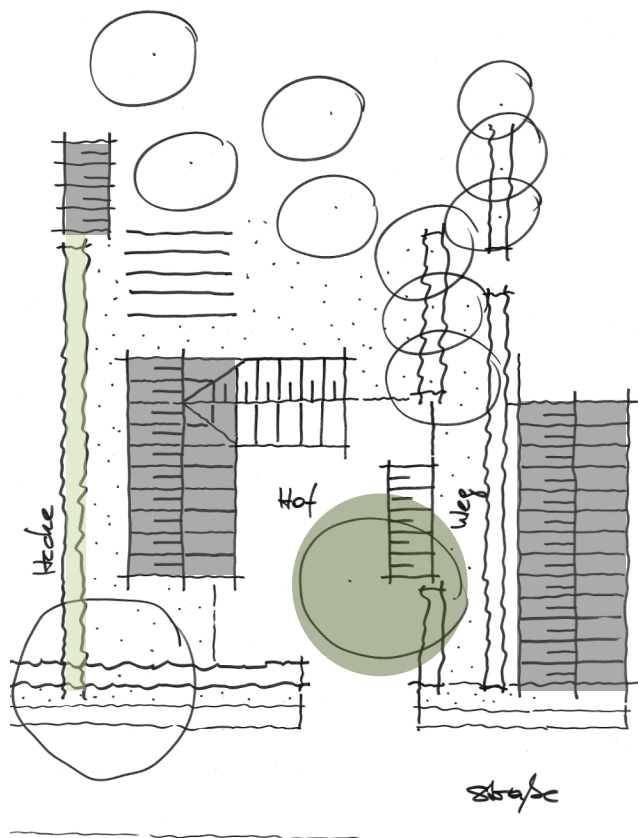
ortstypische Elemente und Funktionen bebauter Grundstücke - Schema / ISL, August 2016
